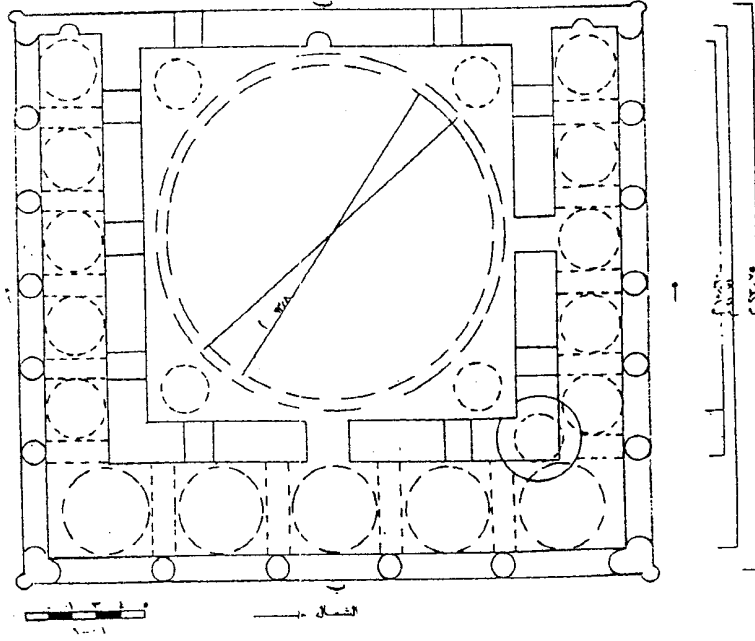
مسقط أفقى للمدرسة التقوية
